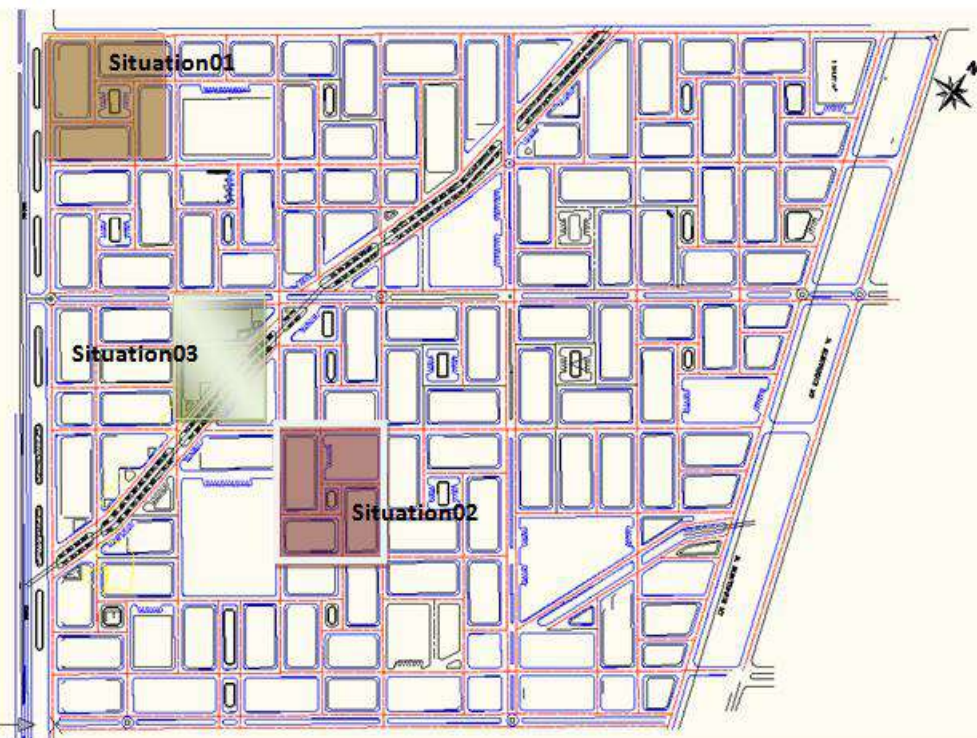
Plan de situation – lotissement Sid el Bachir Source : Auteure (sur le PDAU de BECHAR), Novembre 2021
